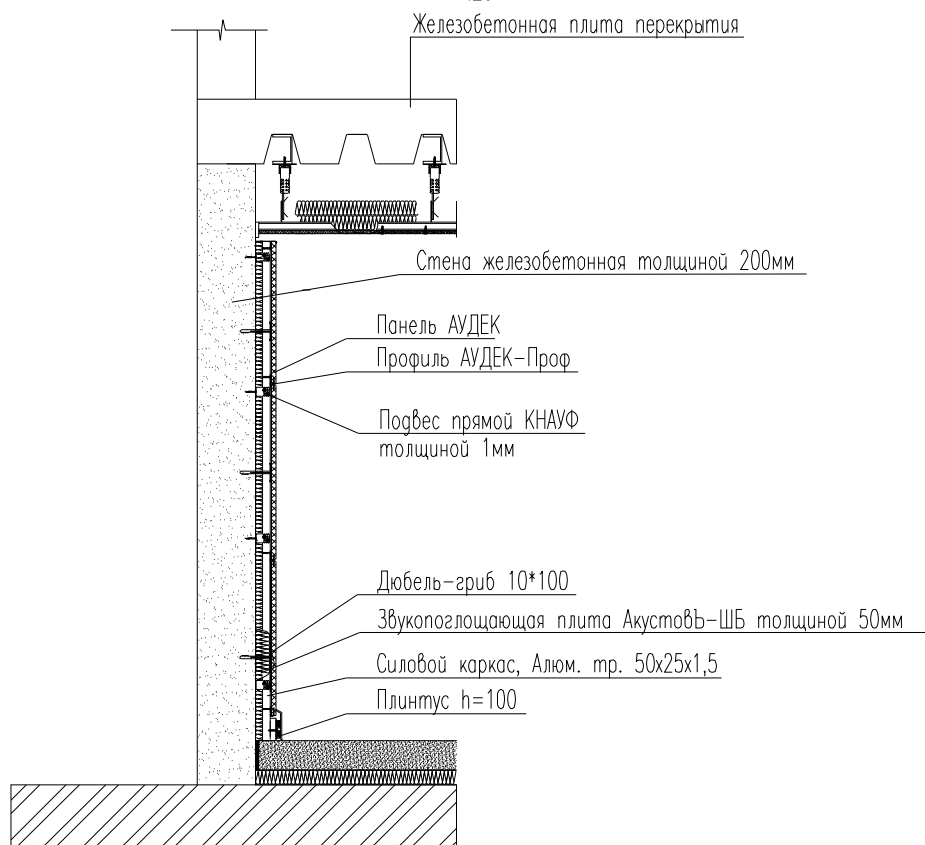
Типовая схема крепления облицовки стен панелями "АУДЕК"
